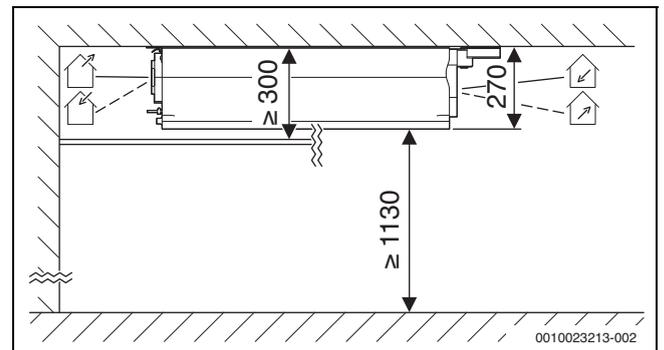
Dimensioni e distanze minime per installazione a soffitto di Logavent
